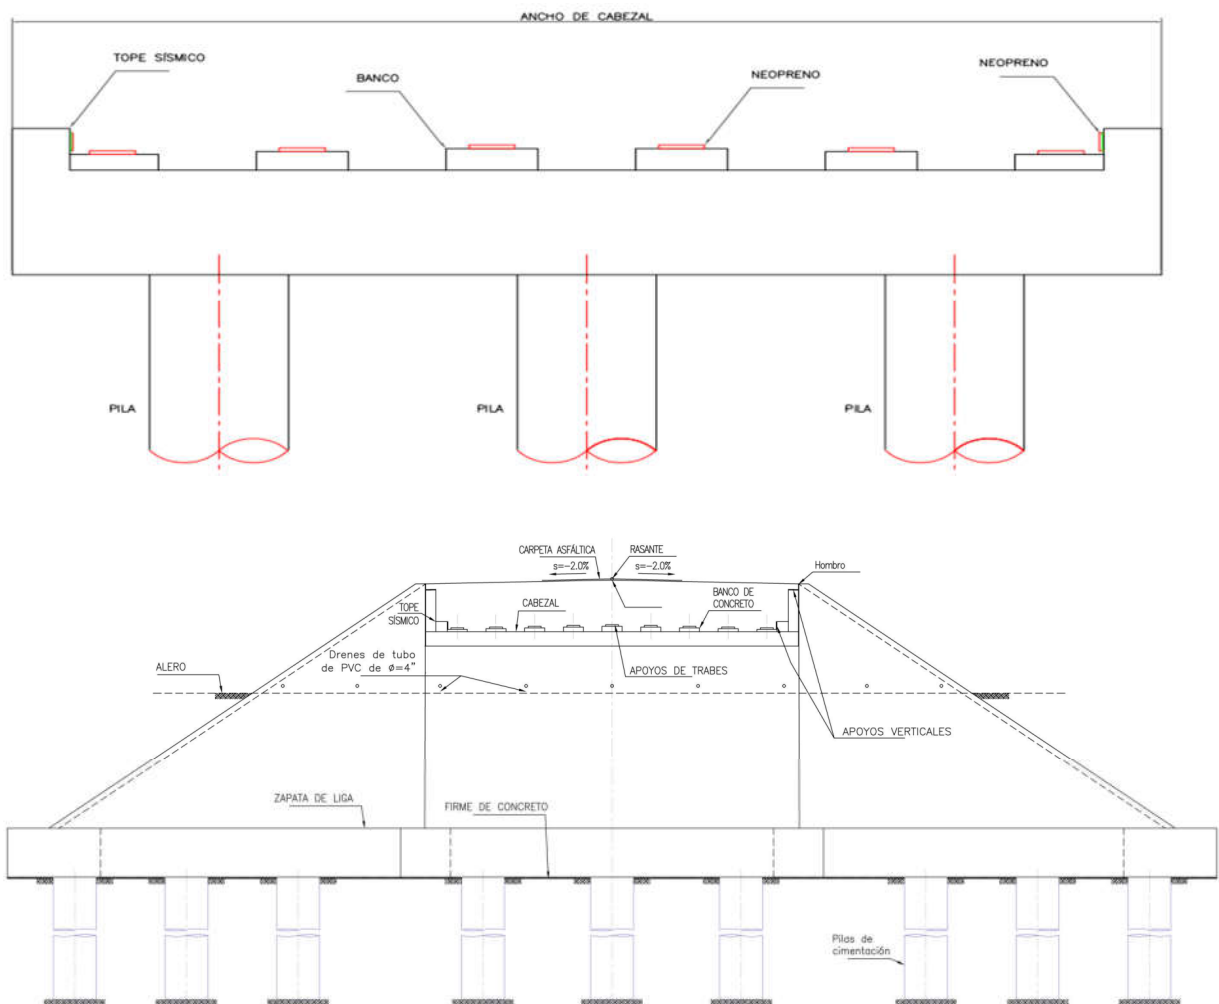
Elementos que conforman la subestructura de un puente (caballete y estribo)
